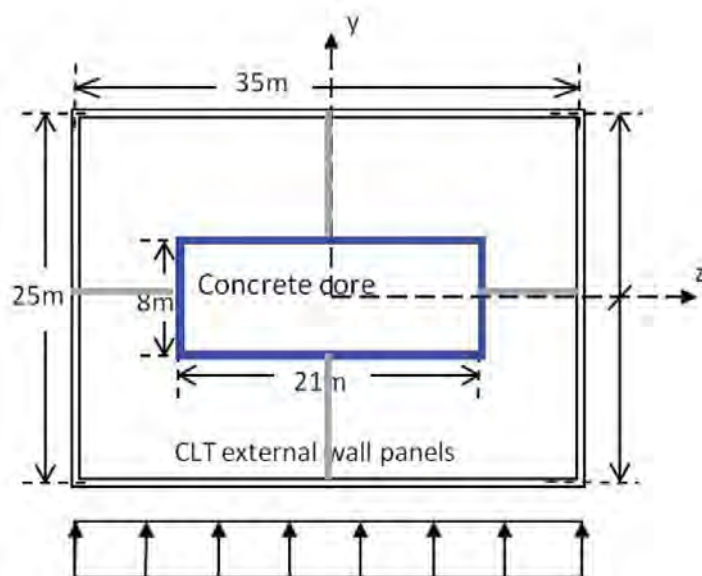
Immagine tratta da “Very tall wooden buildings with cross laminated timber” J.W.G Van De Kuilen et al. 2011.
